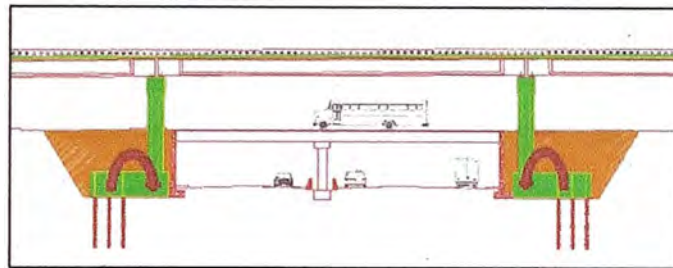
Estabilización para la subpresión de estructuras enterradas
